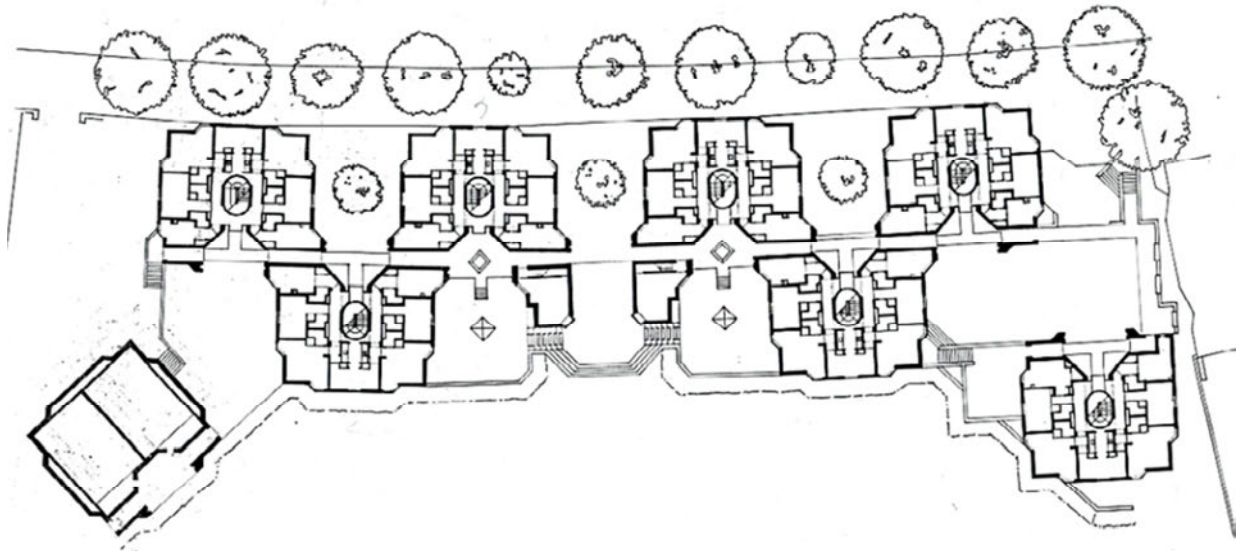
Planta do Pavimento Tipo. Balliol College, no Reino Unido.
